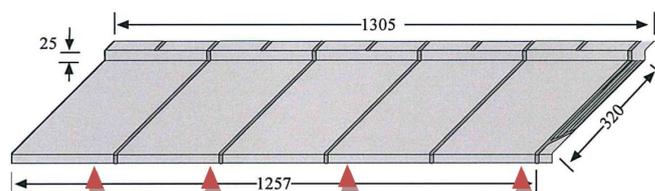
TUILE METROTILE® ELEGANTA - pose des fixations
